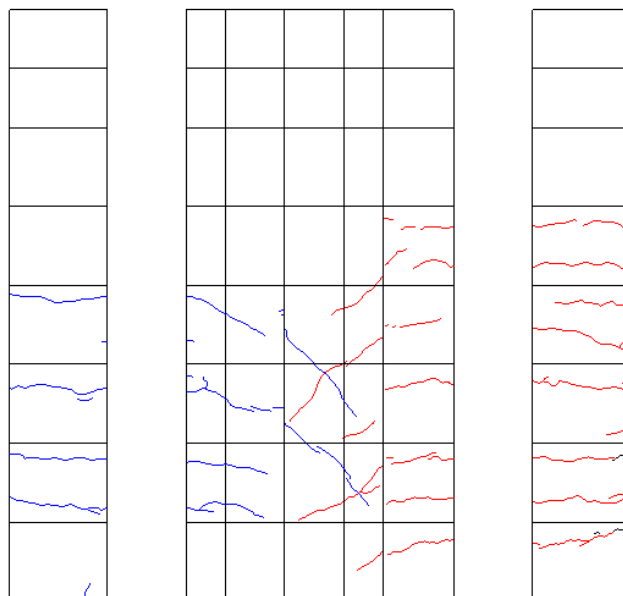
R=-1/400 ひび割れ図
